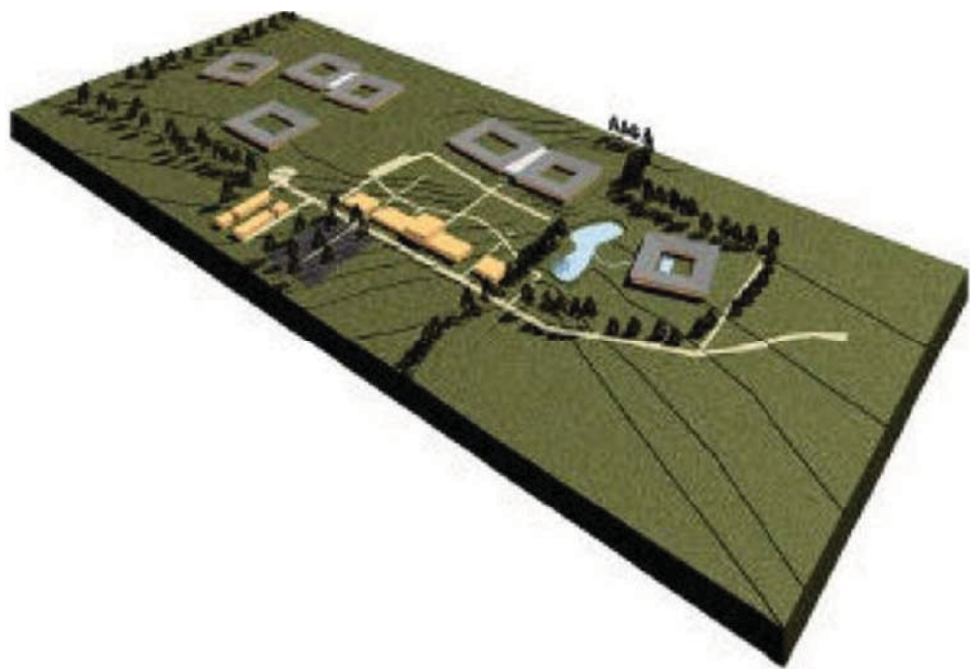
Vista aerea del progetto di ristrutturazione della struttura ospedaliera Fachkrankenhaus Nordfriesland a Bredstedt.
